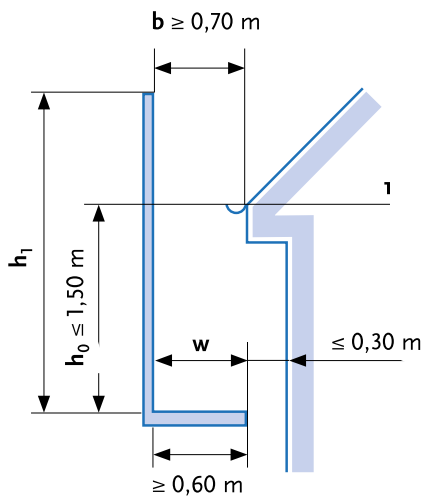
Bauliche Ausbildung der Dachfanggerüste nach DIN 4420-1
